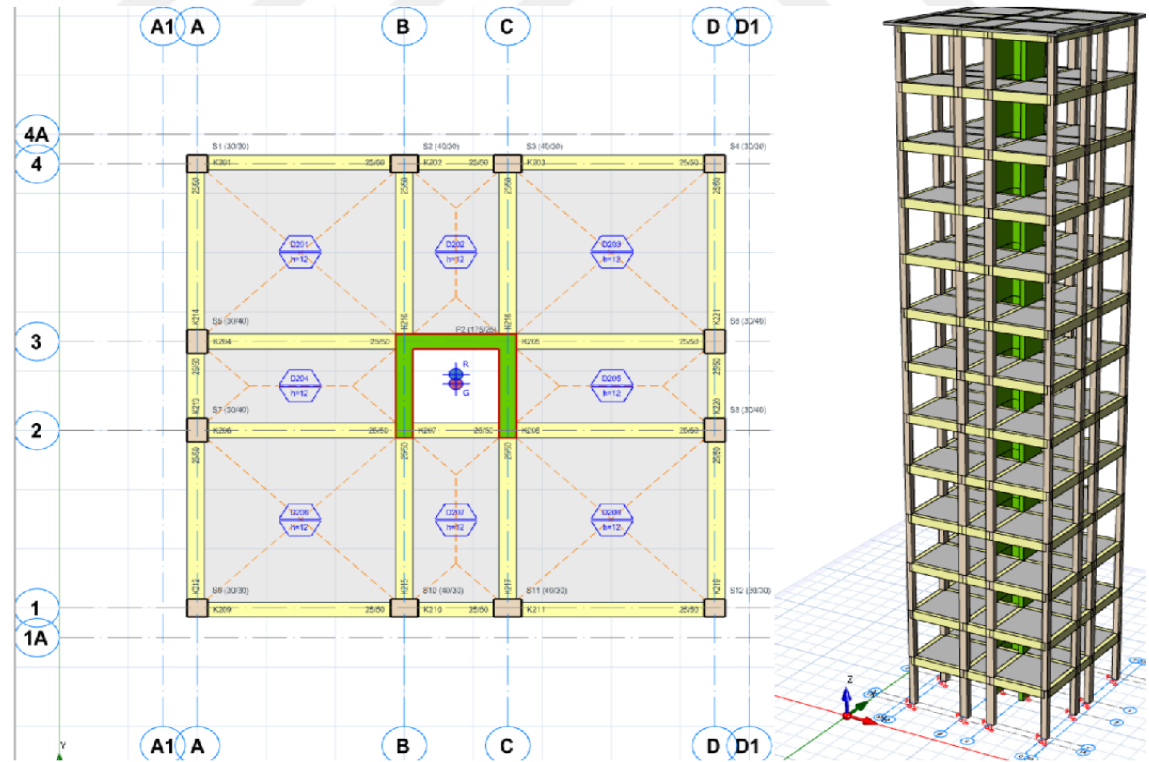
PP_oA1 modelinin 13 katlı yapısının planı ve dış görünümü
